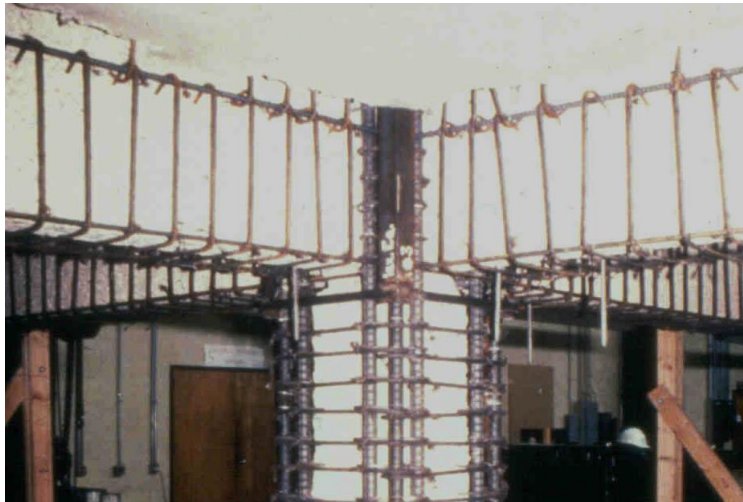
Refuerzo de encamisado de vigas, columnas y nudo (Alcocer, 1991)
